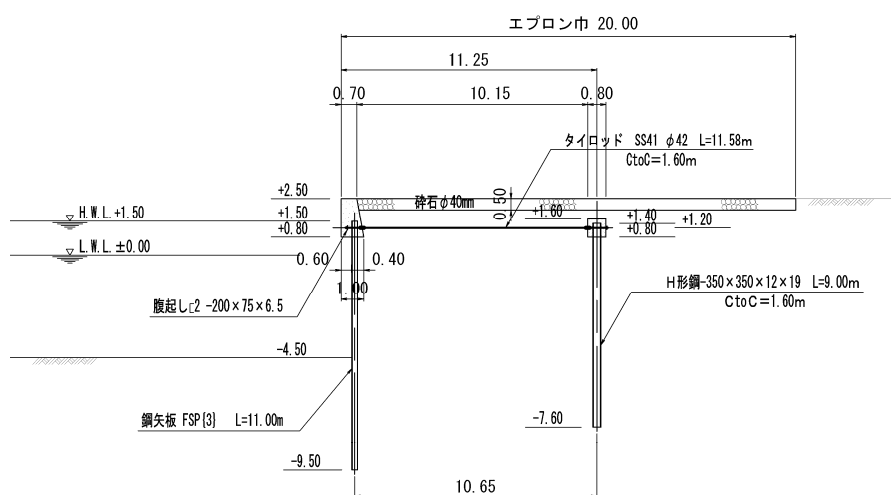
17 No. 1 北側護岸居切導水路側の断面図 (被災前)
